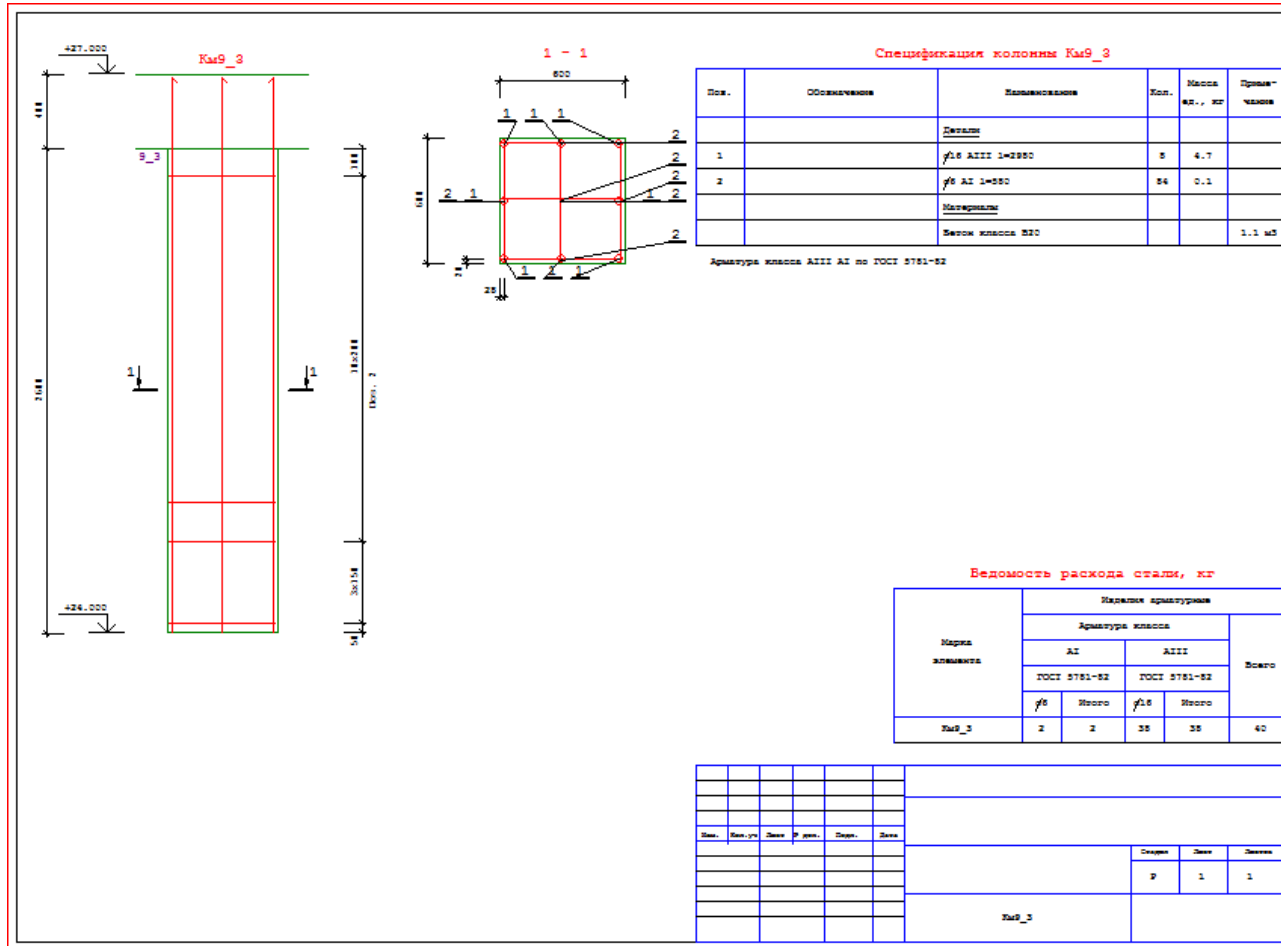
Вариант балково-плитного перекрытия. Колонна К9-3. Кресления рабочего проекта
